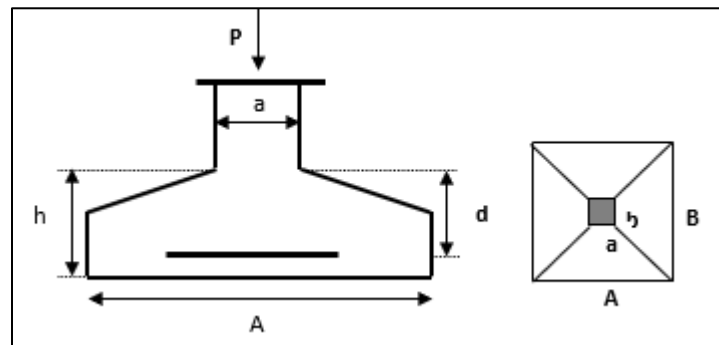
Schéma de semelle isolée sous poteau centré.
